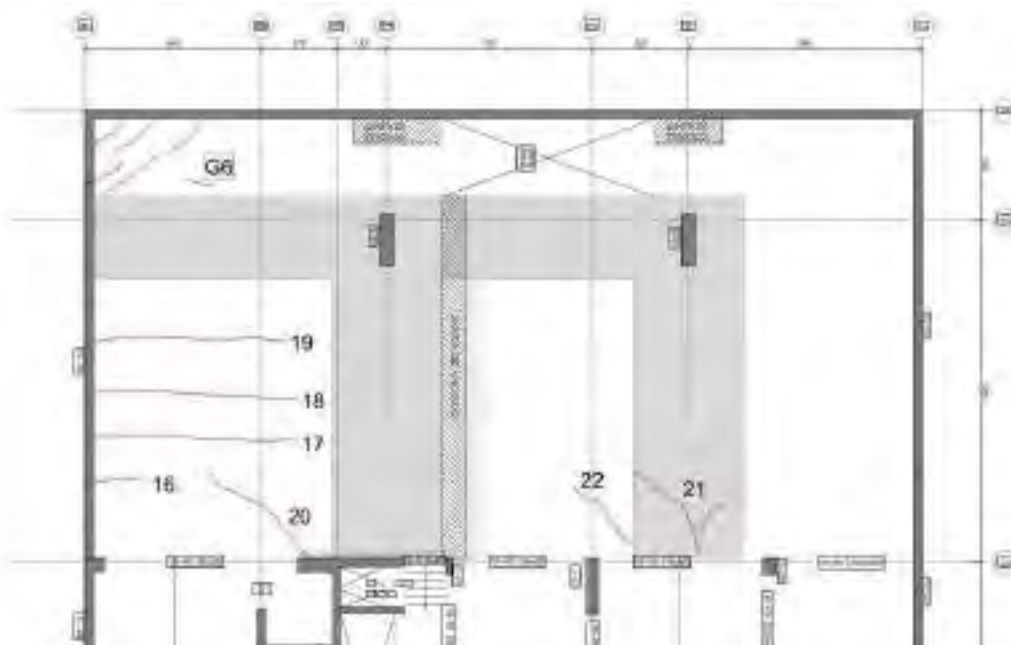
Ubicación de fisuras en sótano 5
